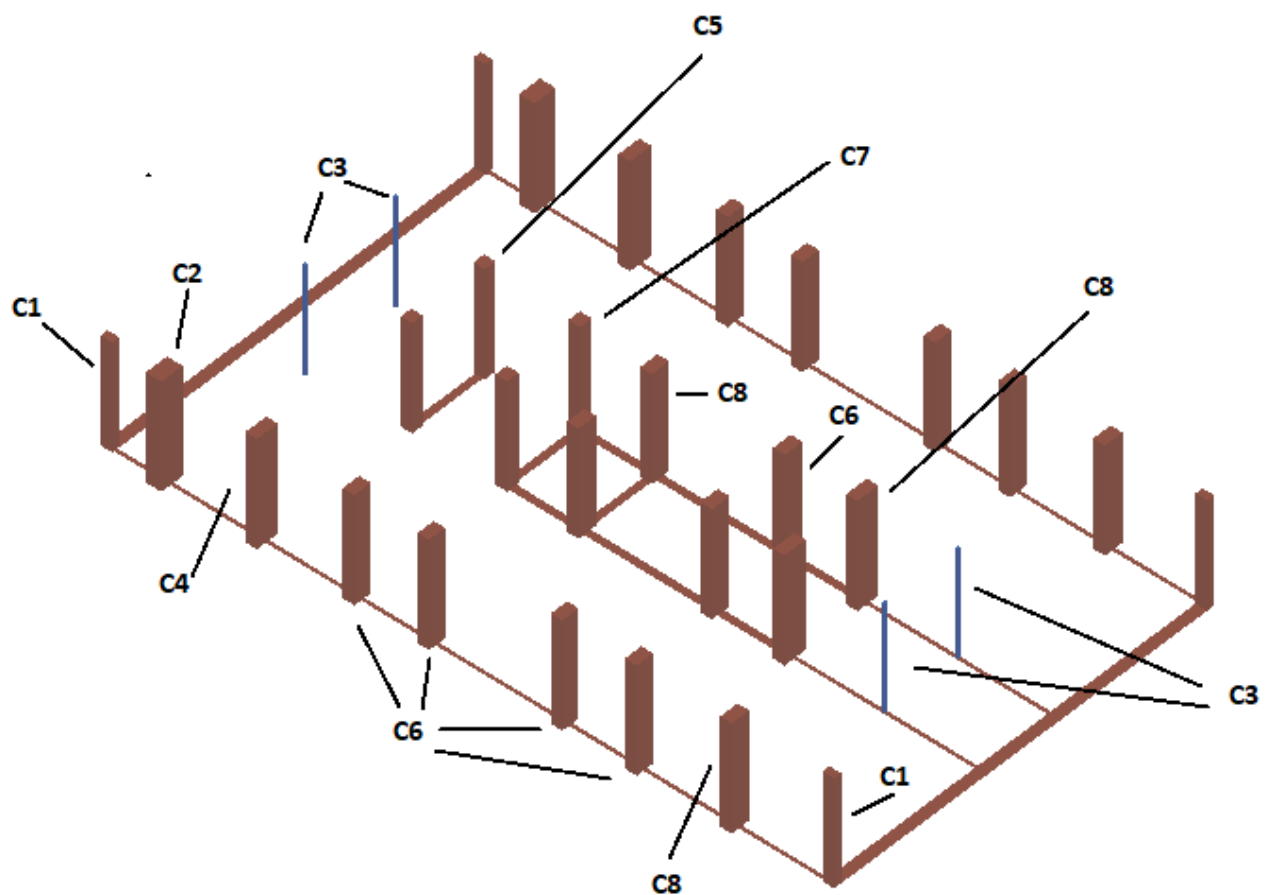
Distribución de las columnas de la planta baja (elaboración propia)
